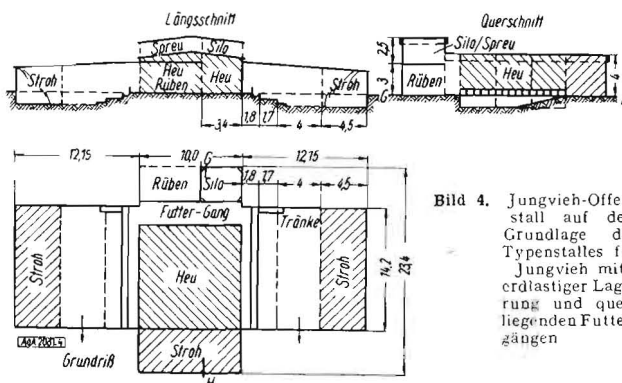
Jungvieh-Offenstall auf der Grundlage des Typenstalles für Jungvieh mit erdlastiger Lagerung und querliegenden Futtergängen
